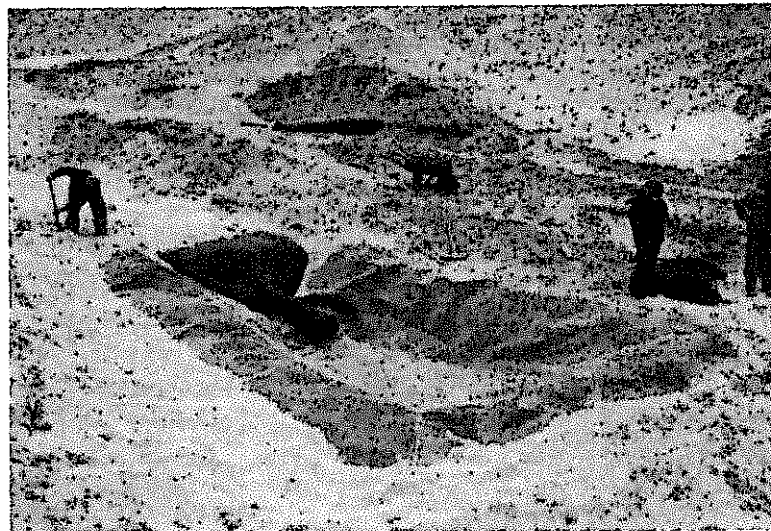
Pozas de contingencia impermeabilizados para monitoreo.
